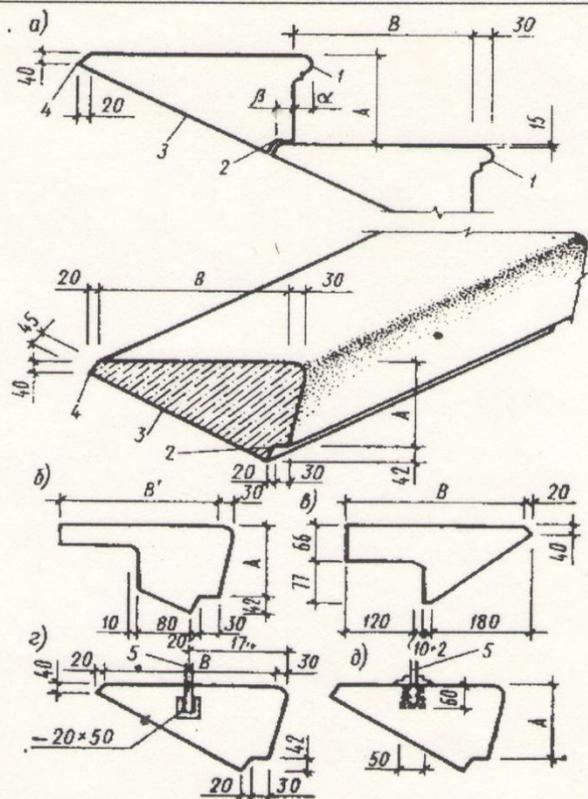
Мелкоэлементная лестница по железобетонным косоурам
